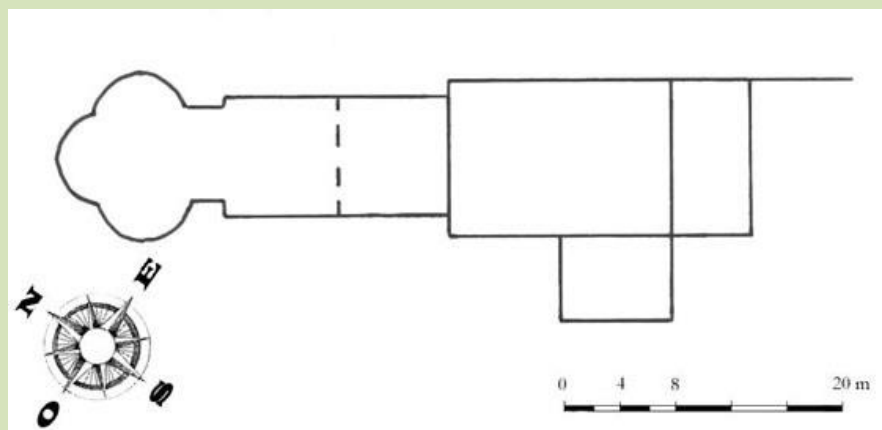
Fotointerpretación de la fotografía aérea de Santa Cruz²⁷⁹
